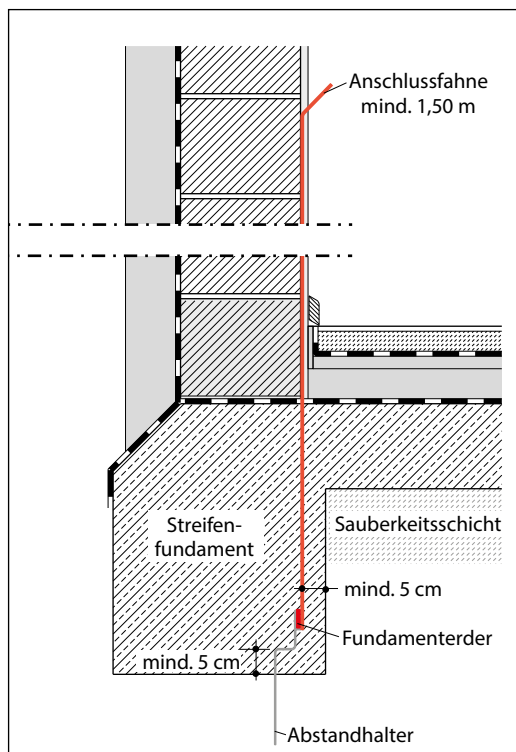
Ausführung eines Fundamenterders im unbewehrten Fundament
